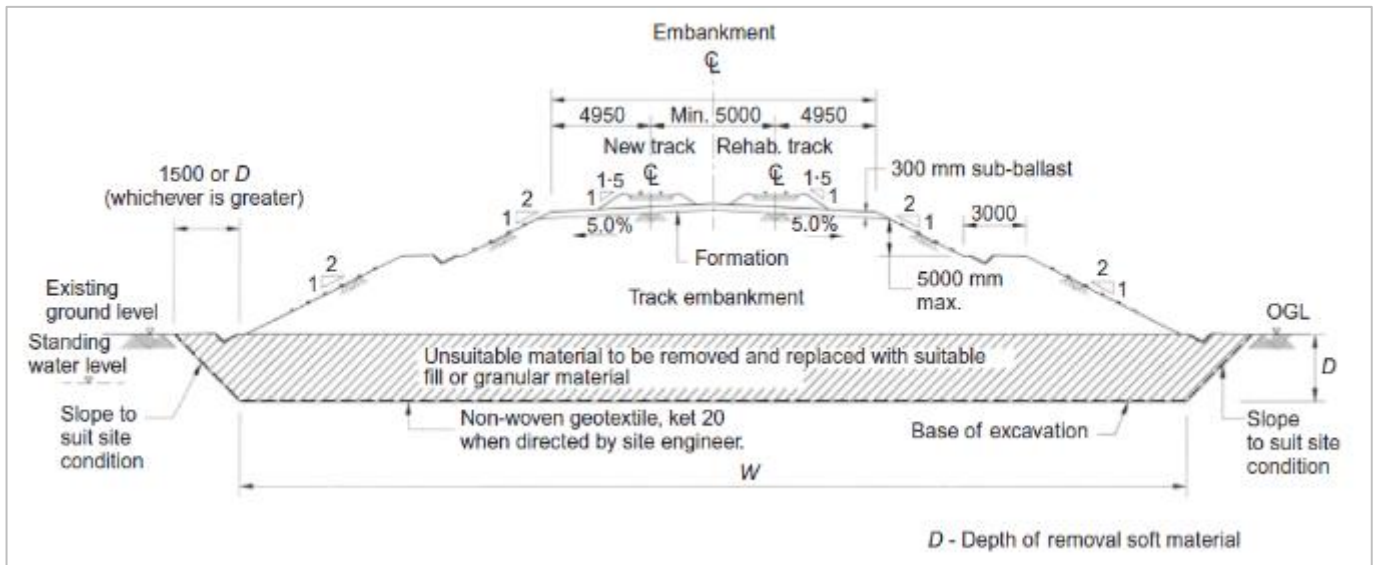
Coupe transversale typique des travaux d'enlèvement et de remplacement
